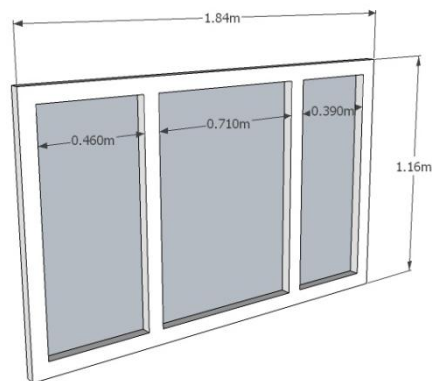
Ventana compuesta VC4. Primer piso, Fachada Norte.
